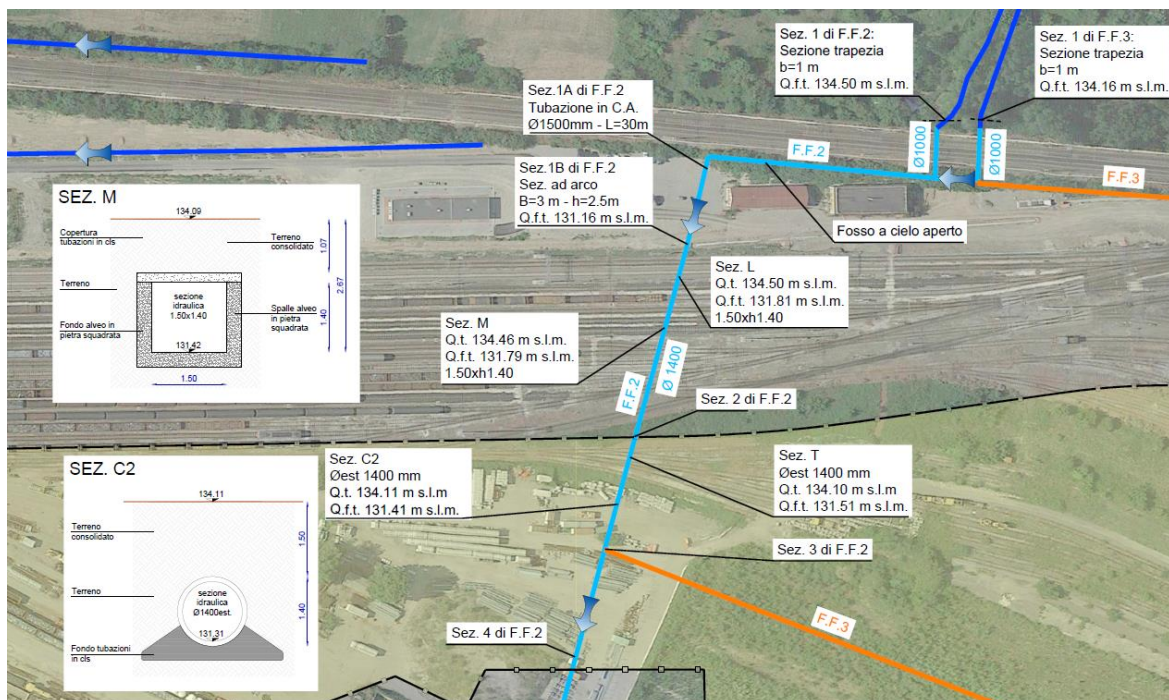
Stralcio "IBS-D059 - Planimetria Stato di fatto Rogge" Elaborato ricompreso nel "Progetto Intermodale Brescia" commissionato da TerAlp.
